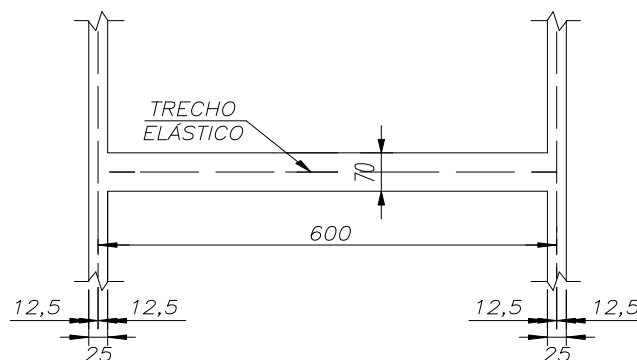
Trecho Rígido e Trecho Elástico em Vigas de 70 Centímetros que se Apoiam em Pilares de 25cm nas Duas Extremidades (Medidas em Centímetro)
